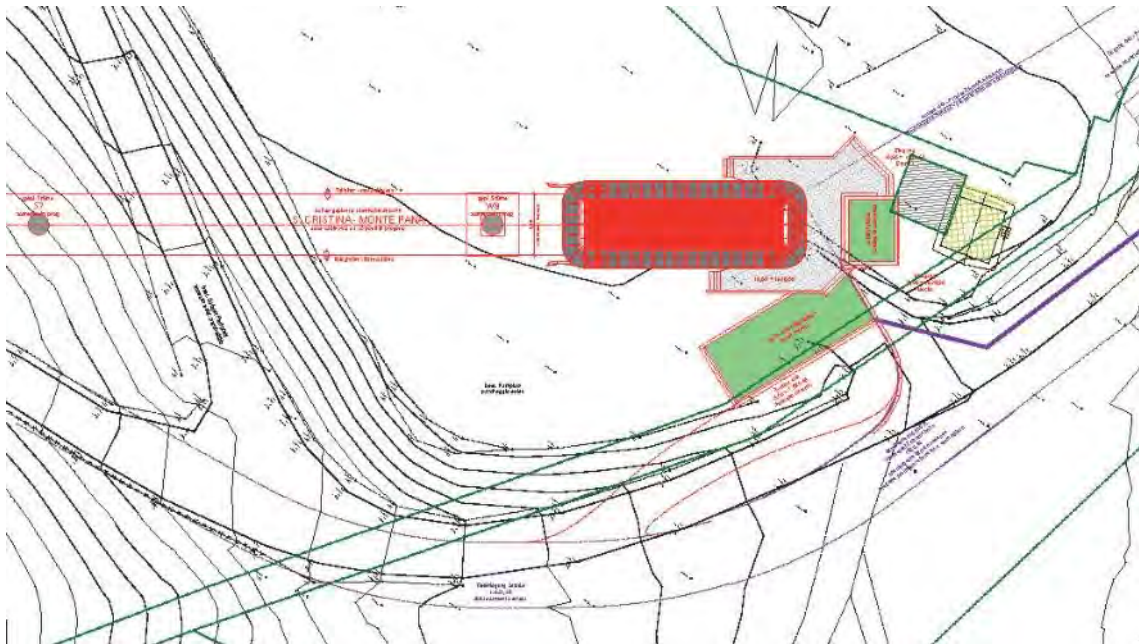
| Alternativa progettuale 1: planimetria della stazione di monte al MONTE PANA
